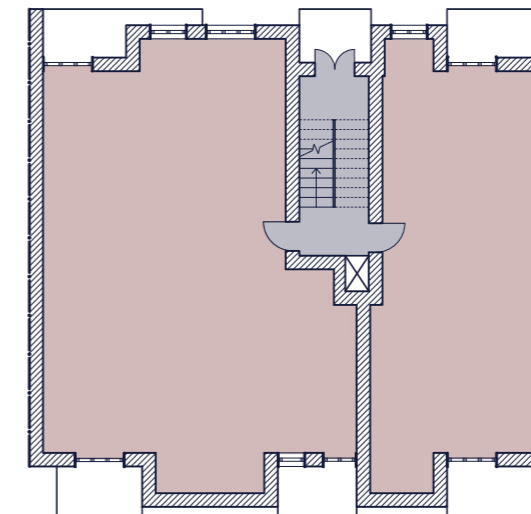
Zone termiche pianta sesto piano, fuori scala.
